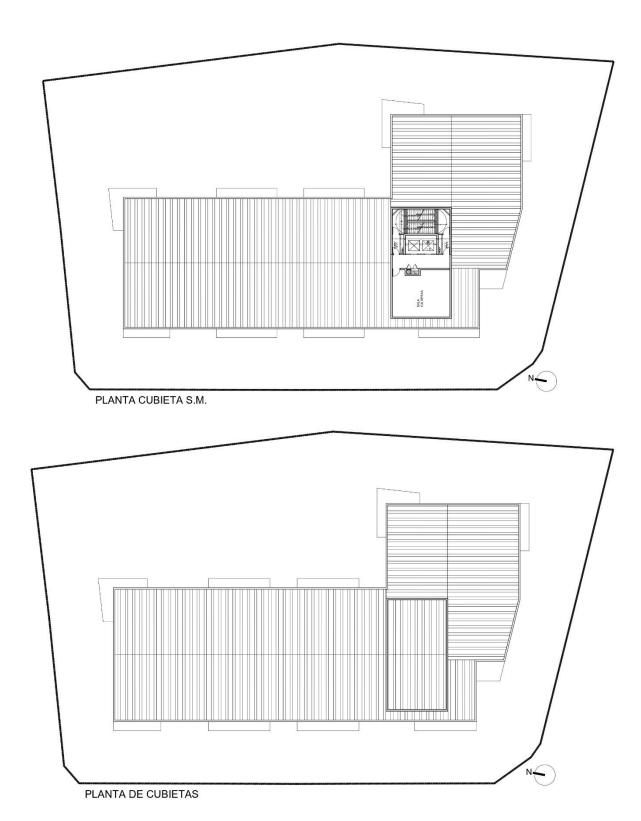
Planta de Cubierta Sala de Máquinas y Planta de Cubiertas, Cabida Indpendent Living. Elaboración Propia.
